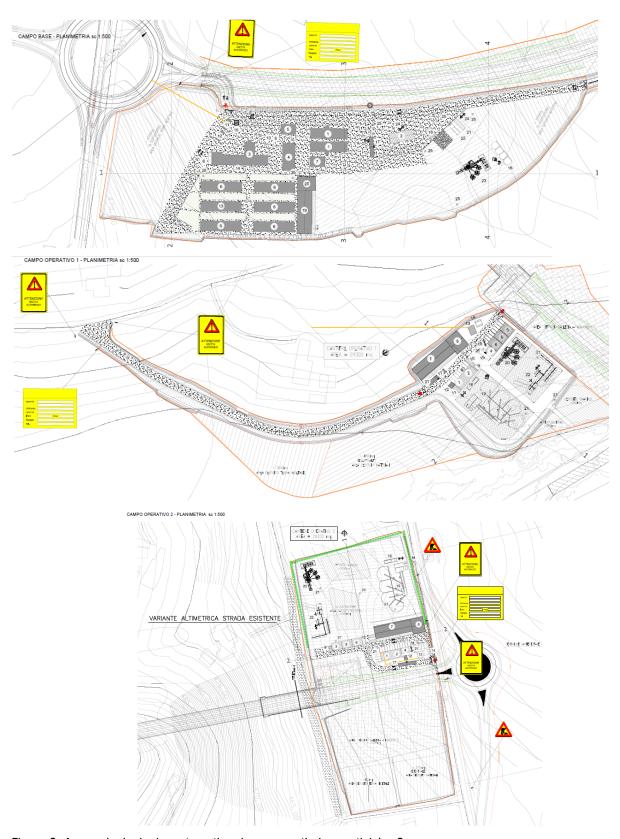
Asse principale: layout cantiere base e cantieri operativi 1 e 2
